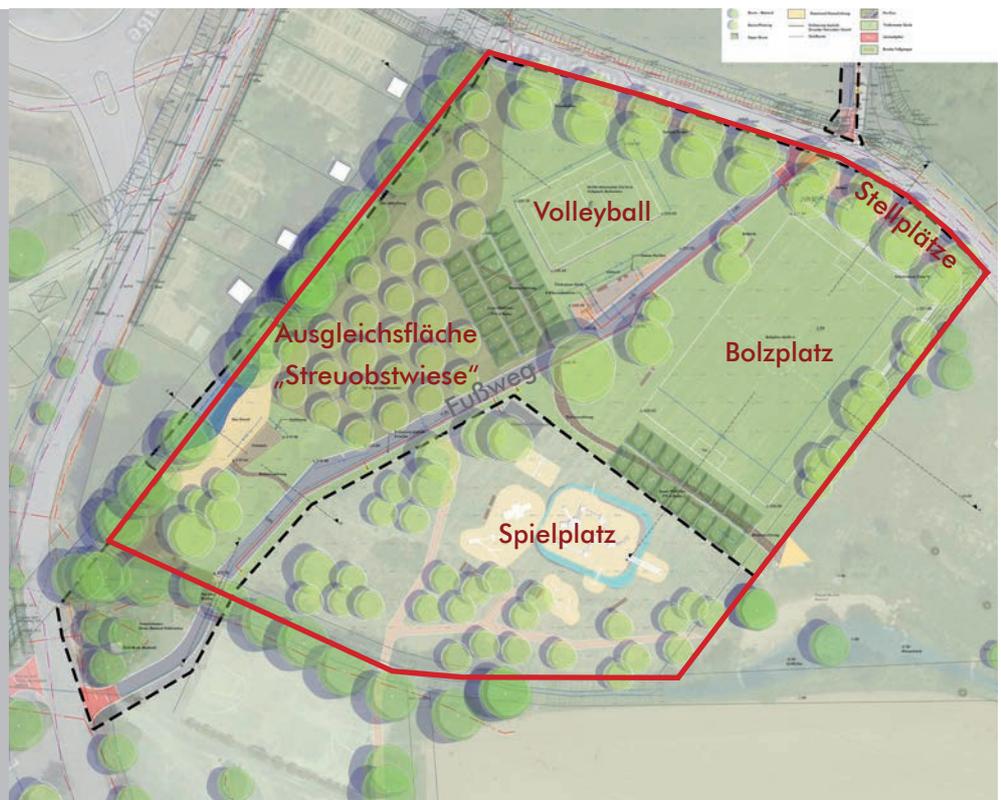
Grundlage zur Ermittlung der Eingriffsschwere (rote Umrandung)
